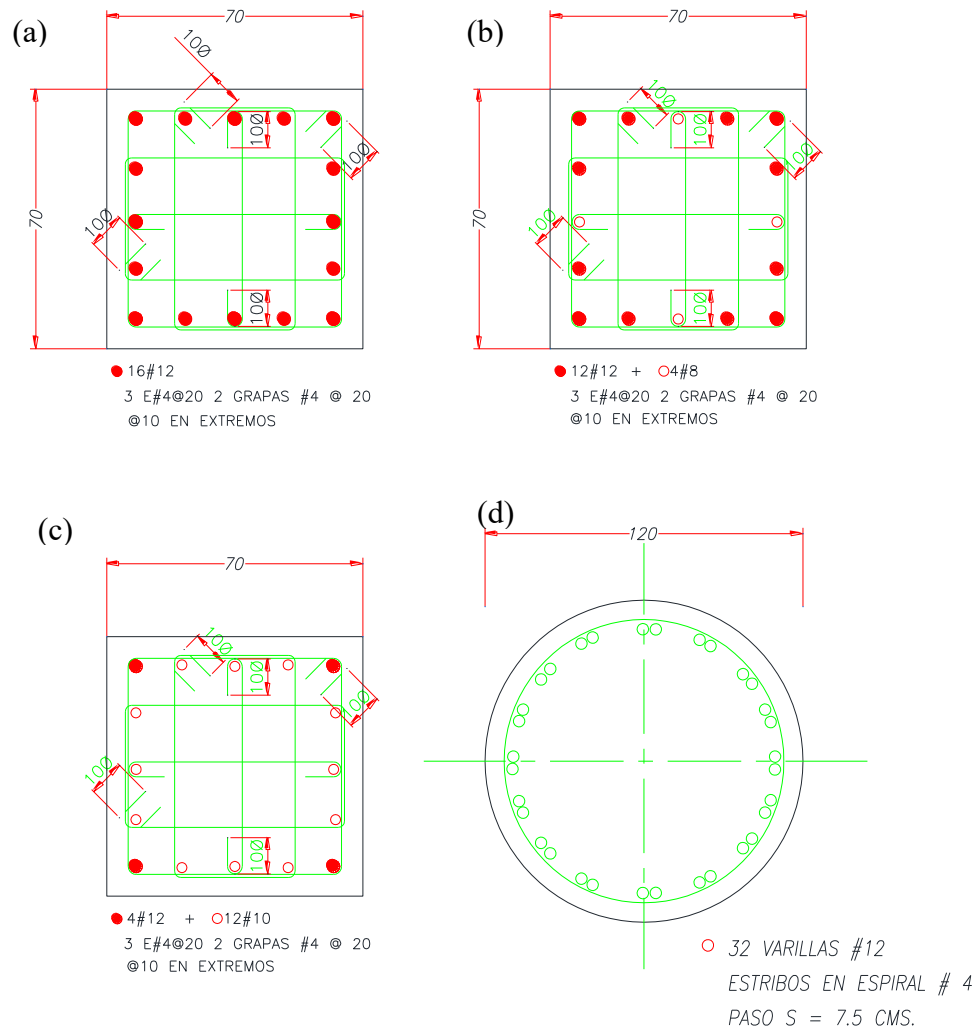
Armado de columnas tipo del edificio E1-H (a) C-1 (b) C-2 (c) C-3 y (d) C-4
